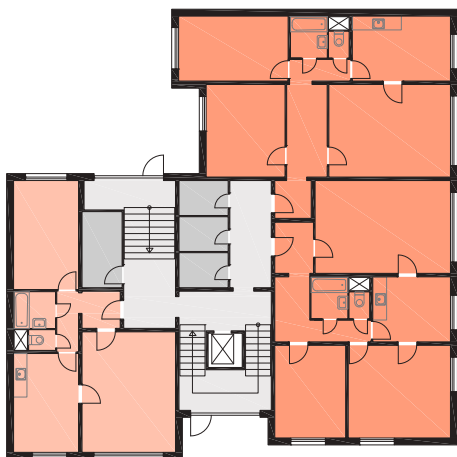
Konstrukční soustava OP 1.31 - Frýdlant nad Ostravicí (Zdroj: panelaky.info)
